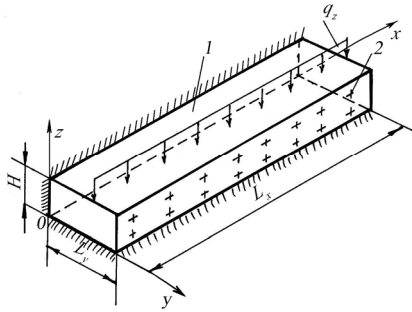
Расчетная схема стенки монтажного ходка: 1 – стенка выработки; 2 – анкеры
